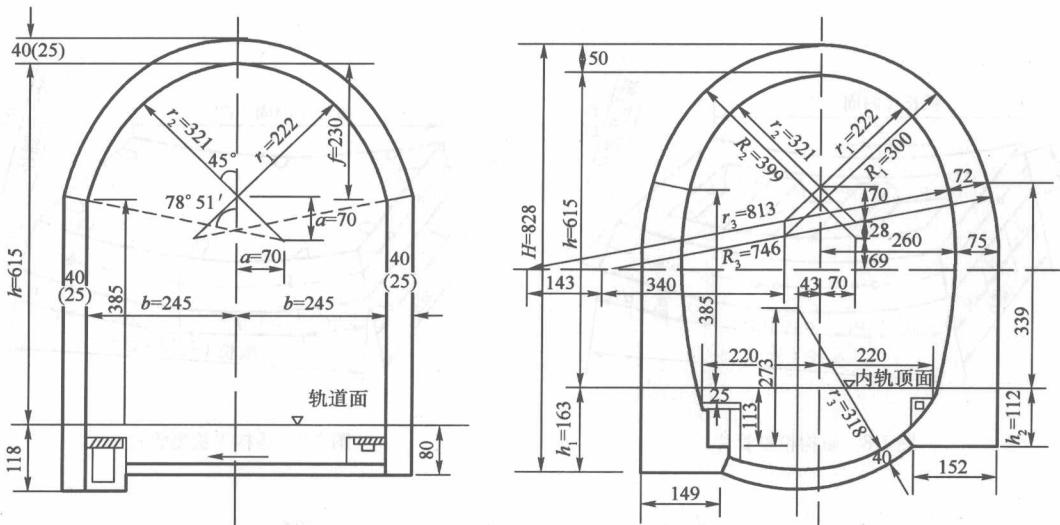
铁路隧道常用的马蹄形衬砌结构断面图(尺寸单位:cm)
